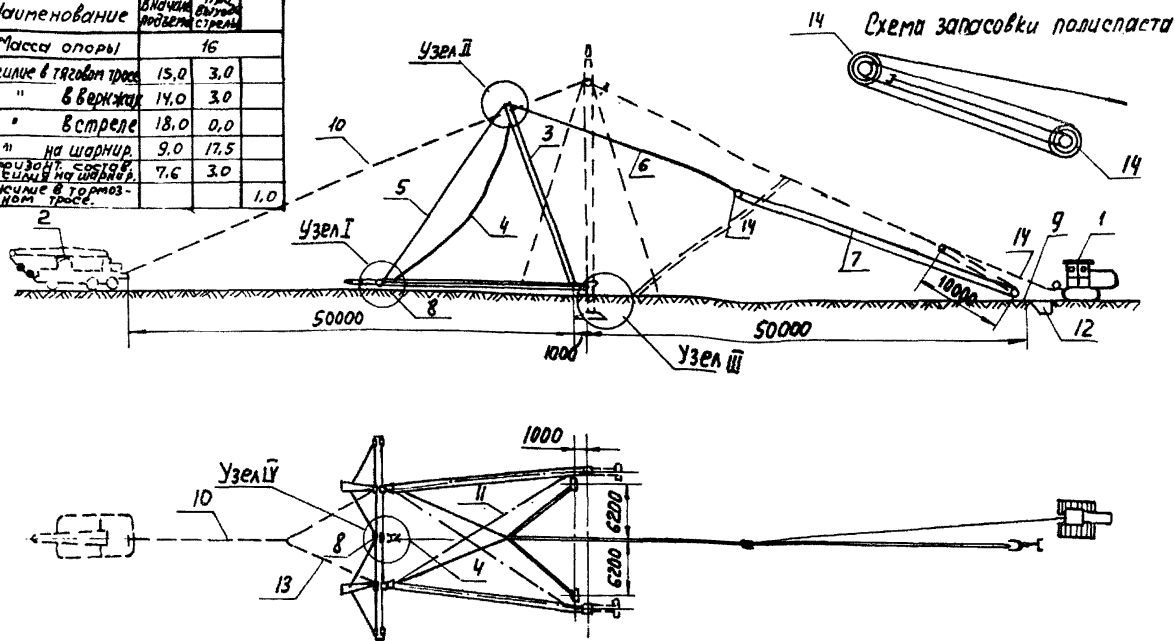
Схема подъема промежуточной железобетонной опоры ПБ-500-1.
